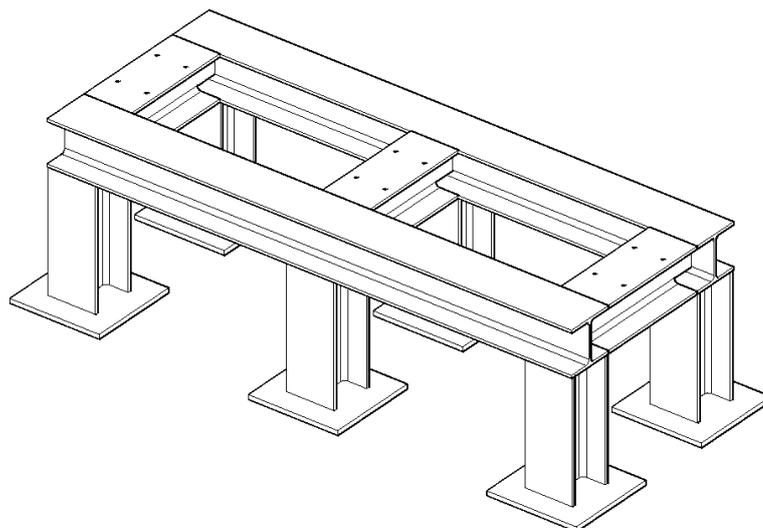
Estructura del alimentador vibrante. Fuente: elaboración propia.
